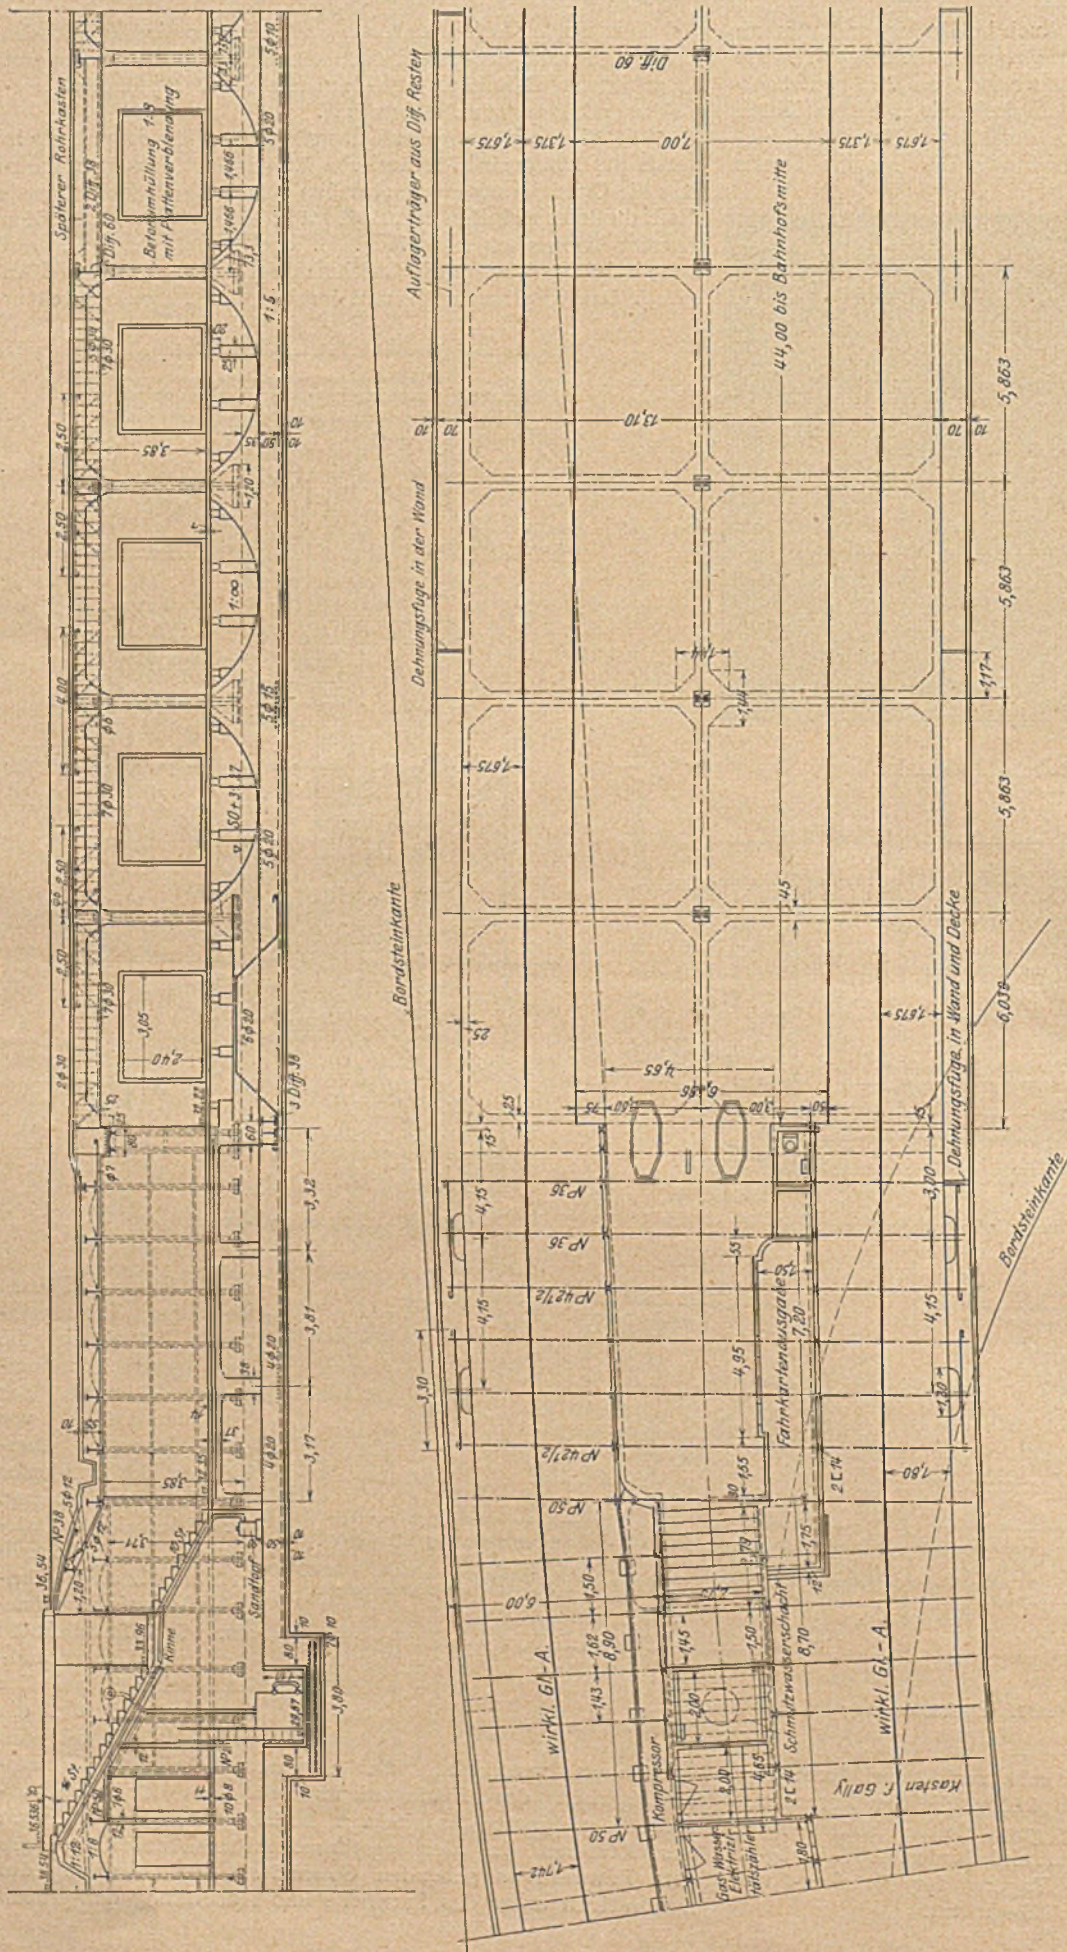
Längsschnitt und Grundriß des Untergrundbahnhofes Hasenheide.
